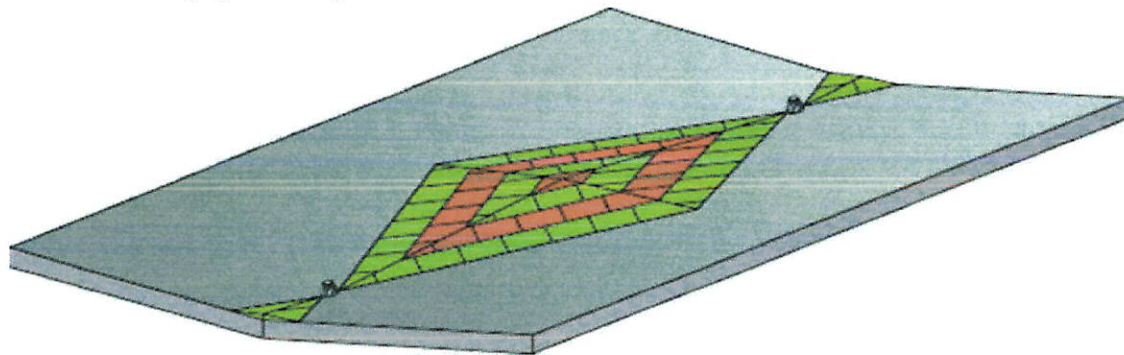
Схема установки клиновидных плит теплоизоляции в ендове
